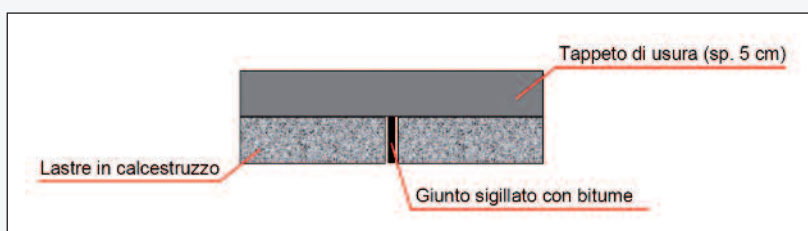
La sezione tipo dell'intervento di ripristino tradizionale
